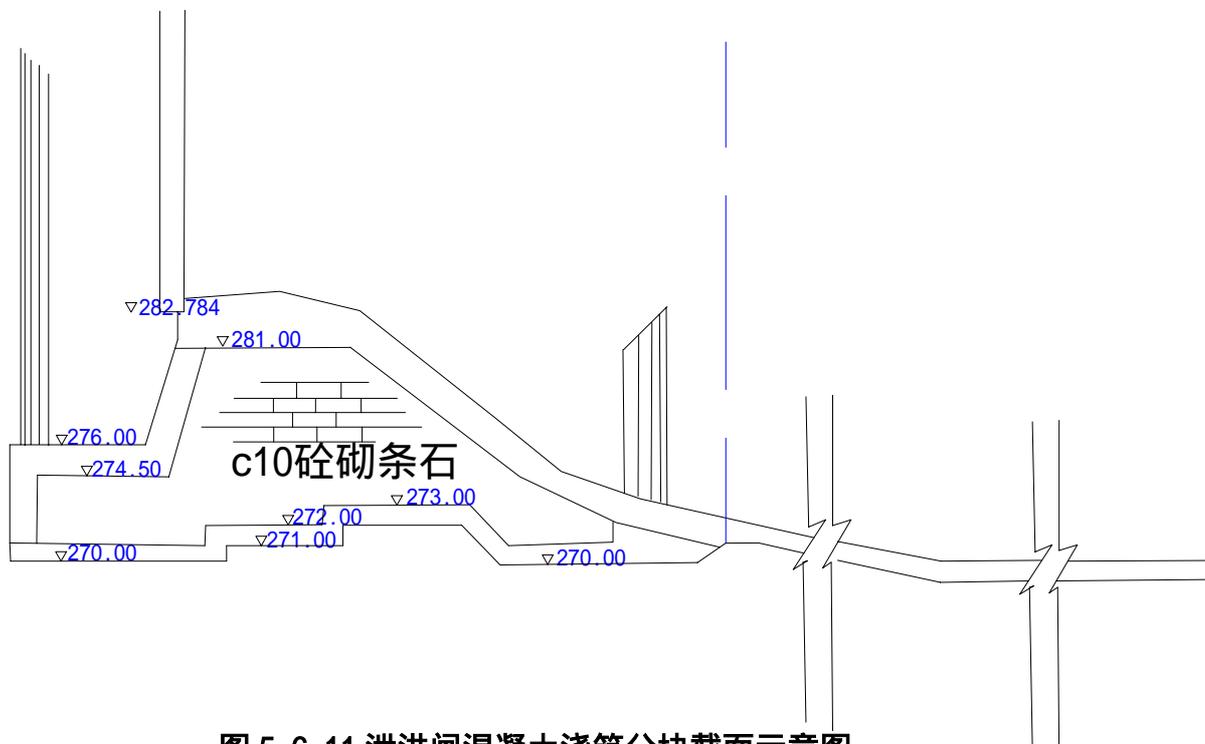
泄洪闸混凝土浇筑分块截面示意图
